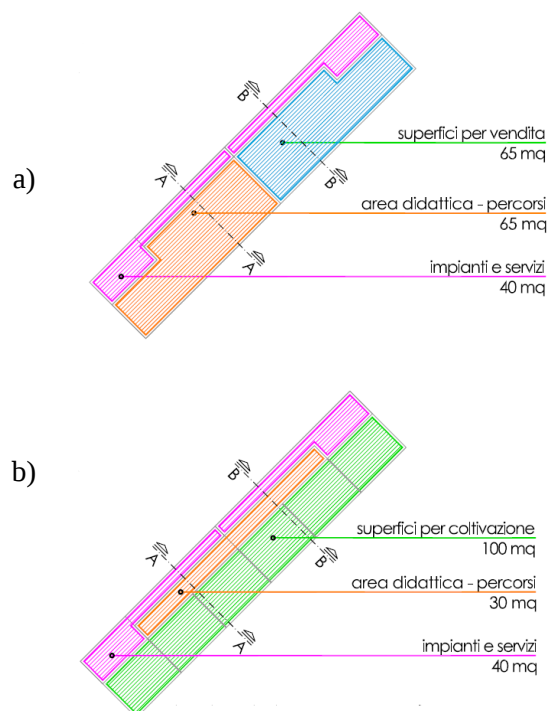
Torre Lineare, planimetria piano terra (a) e piano tipo (b) – distribuzione schematica delle funzioni
